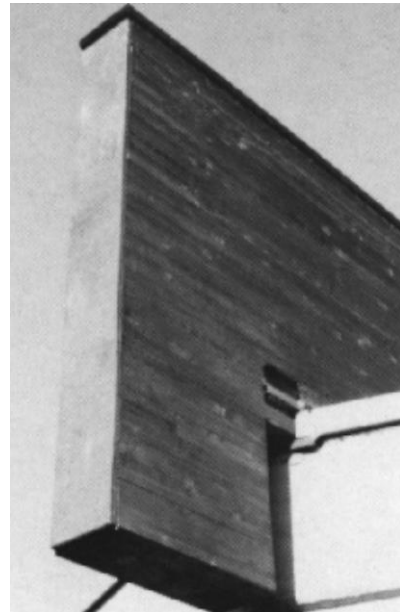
Ende eines Brettschichtholzbinders über der Fassade
